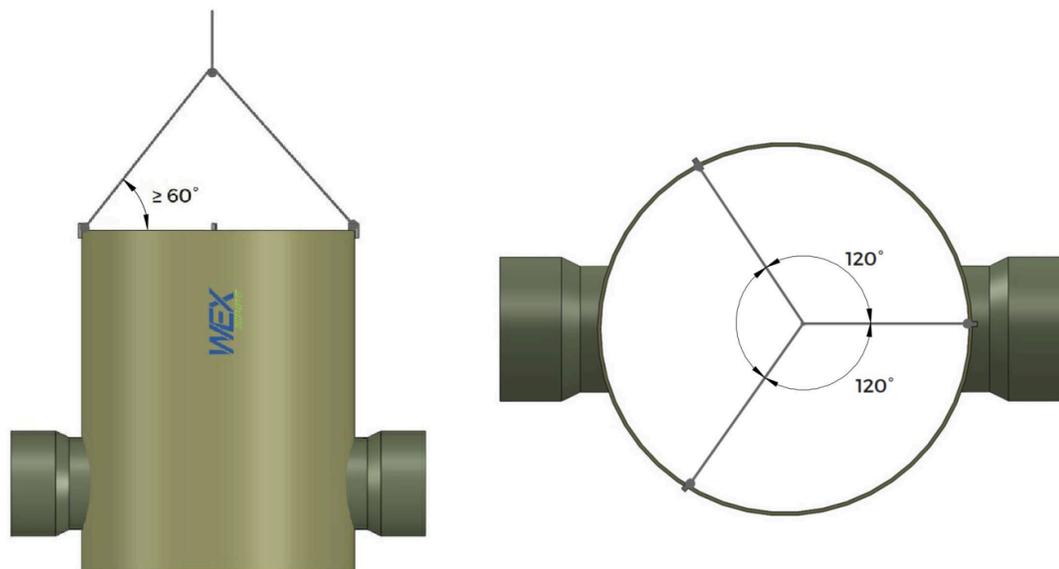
Puntos de apoyo para bocas de inspección y accesorios.
